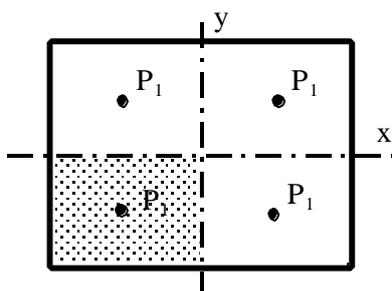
Doppelt-symmetrisch belastete Fundamentplatte
